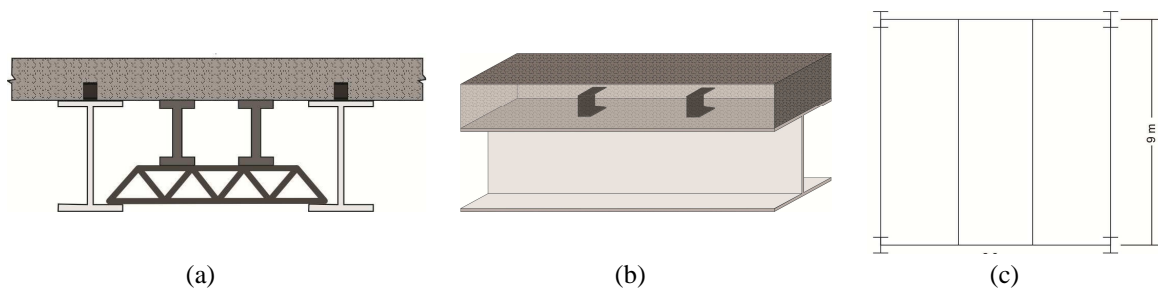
Viga mista do estudo de caso 2: (a) Vista frontal; (b) Vista lateral; e (c) Vista superior.
